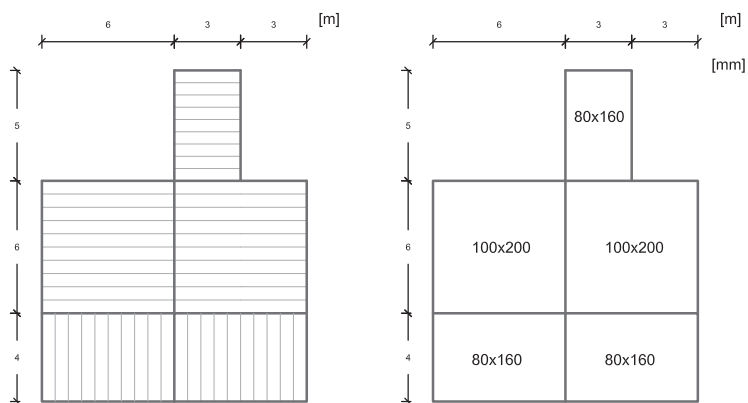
Secção transversal das vigas secundárias num piso de cobertura
